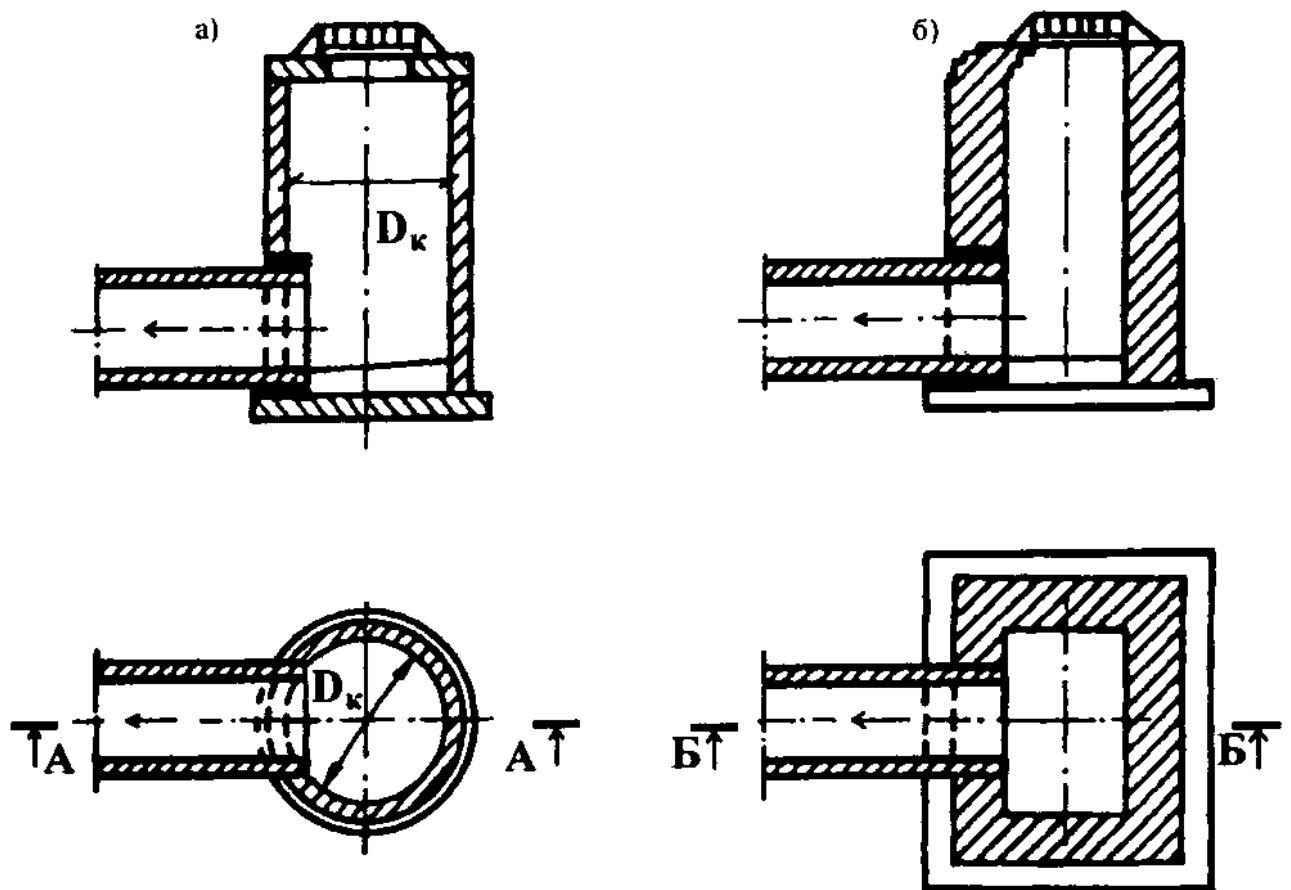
Дождеприемники: а - круглые, железобетонные; б - прямоугольные, кирпичные
